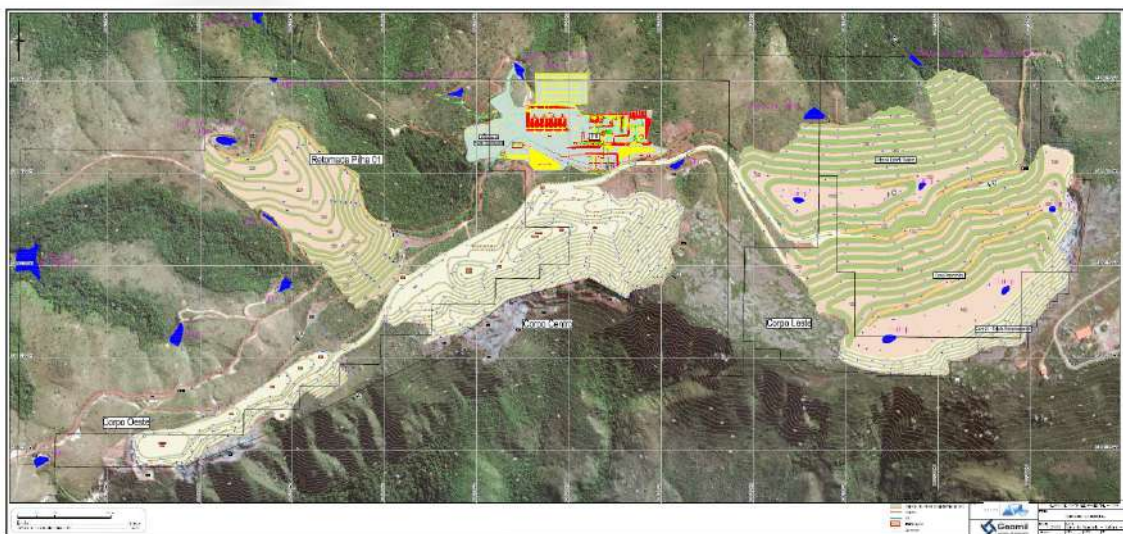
Vista em planta da mina do Brumado com instalações (UTM e outros) pit final (Cavas 1 e 2), pilhas de estéril (retomada e construída) e localização das bacias de contenção de sedimentos.
